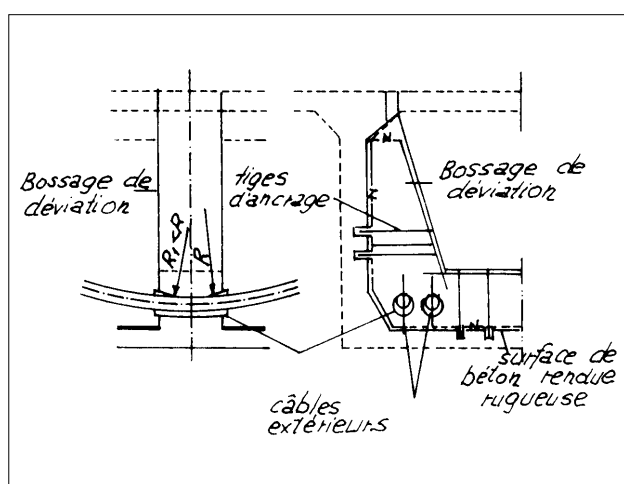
Zone de déviation – introduction des forces au moyen d'une construction en béton armé (FIP, 1991).
